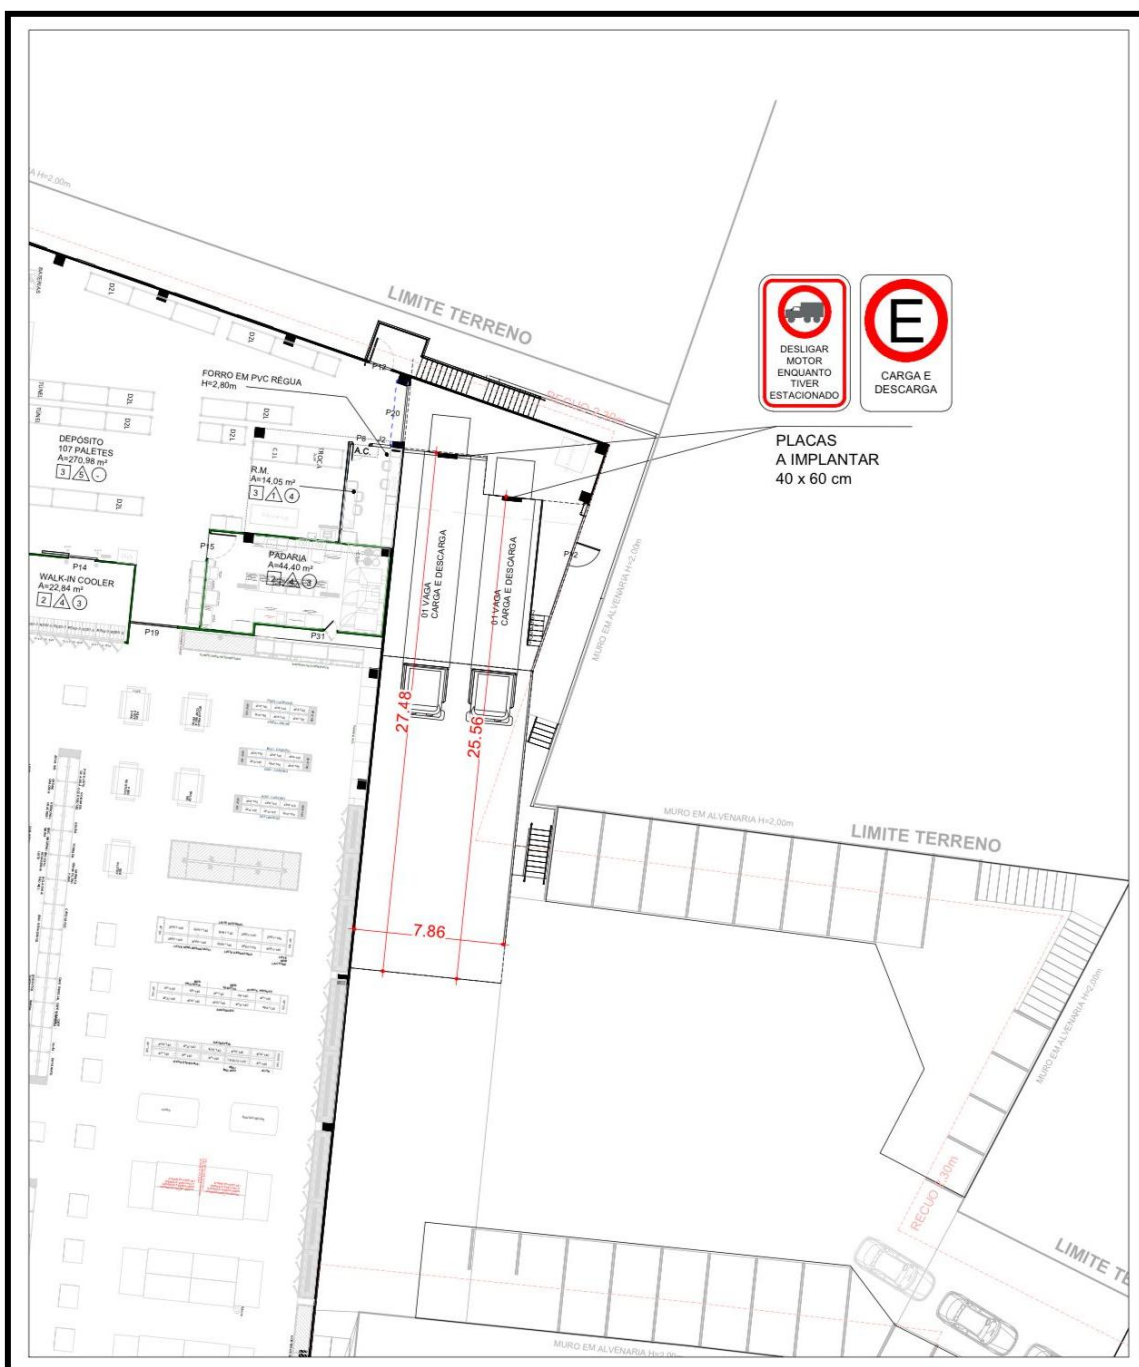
Detalhes das vagas Carga/Descarga - Pavimento térreo. Fonte: Projeto Arquitetônico, 2025.
